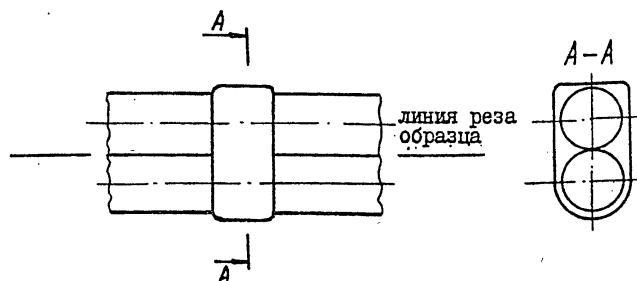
Схема резки сварного соединения спаренных стержней арматуры на два "образца-свидетеля"
